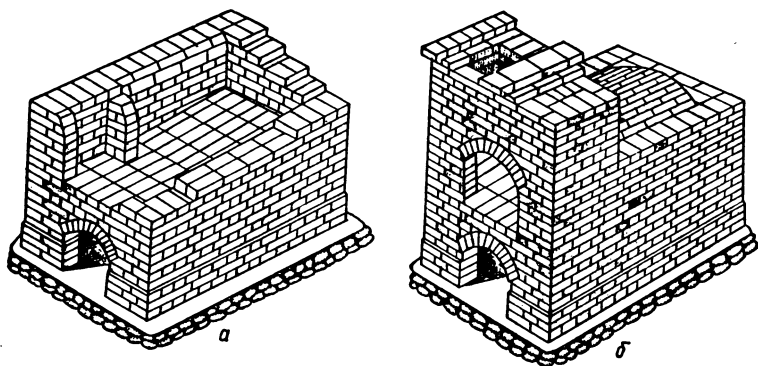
Формирование горнила устья, топочного проема и щитка русской печи:
